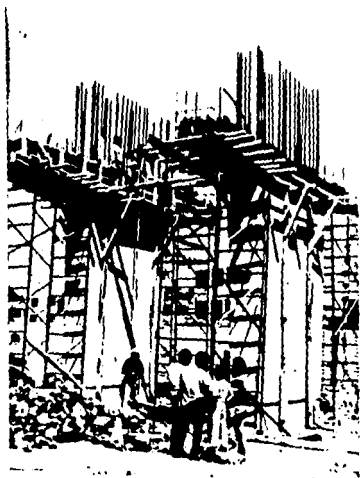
CIMBRA EN LOS CABEZALES.
